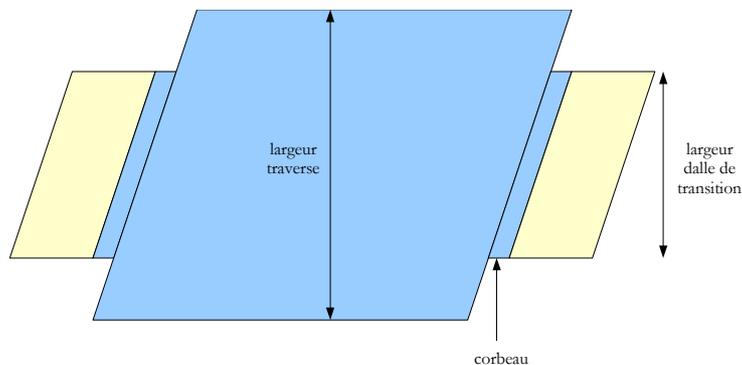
Extension de la traverse par un corbeau (vue en plan)
